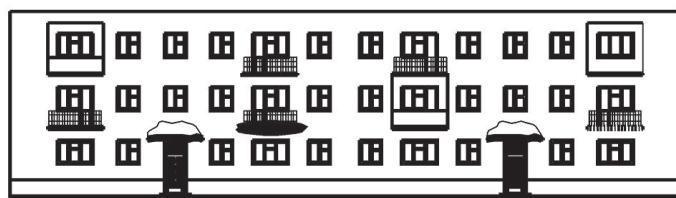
Схема фасаду з нанесенням дефектів
